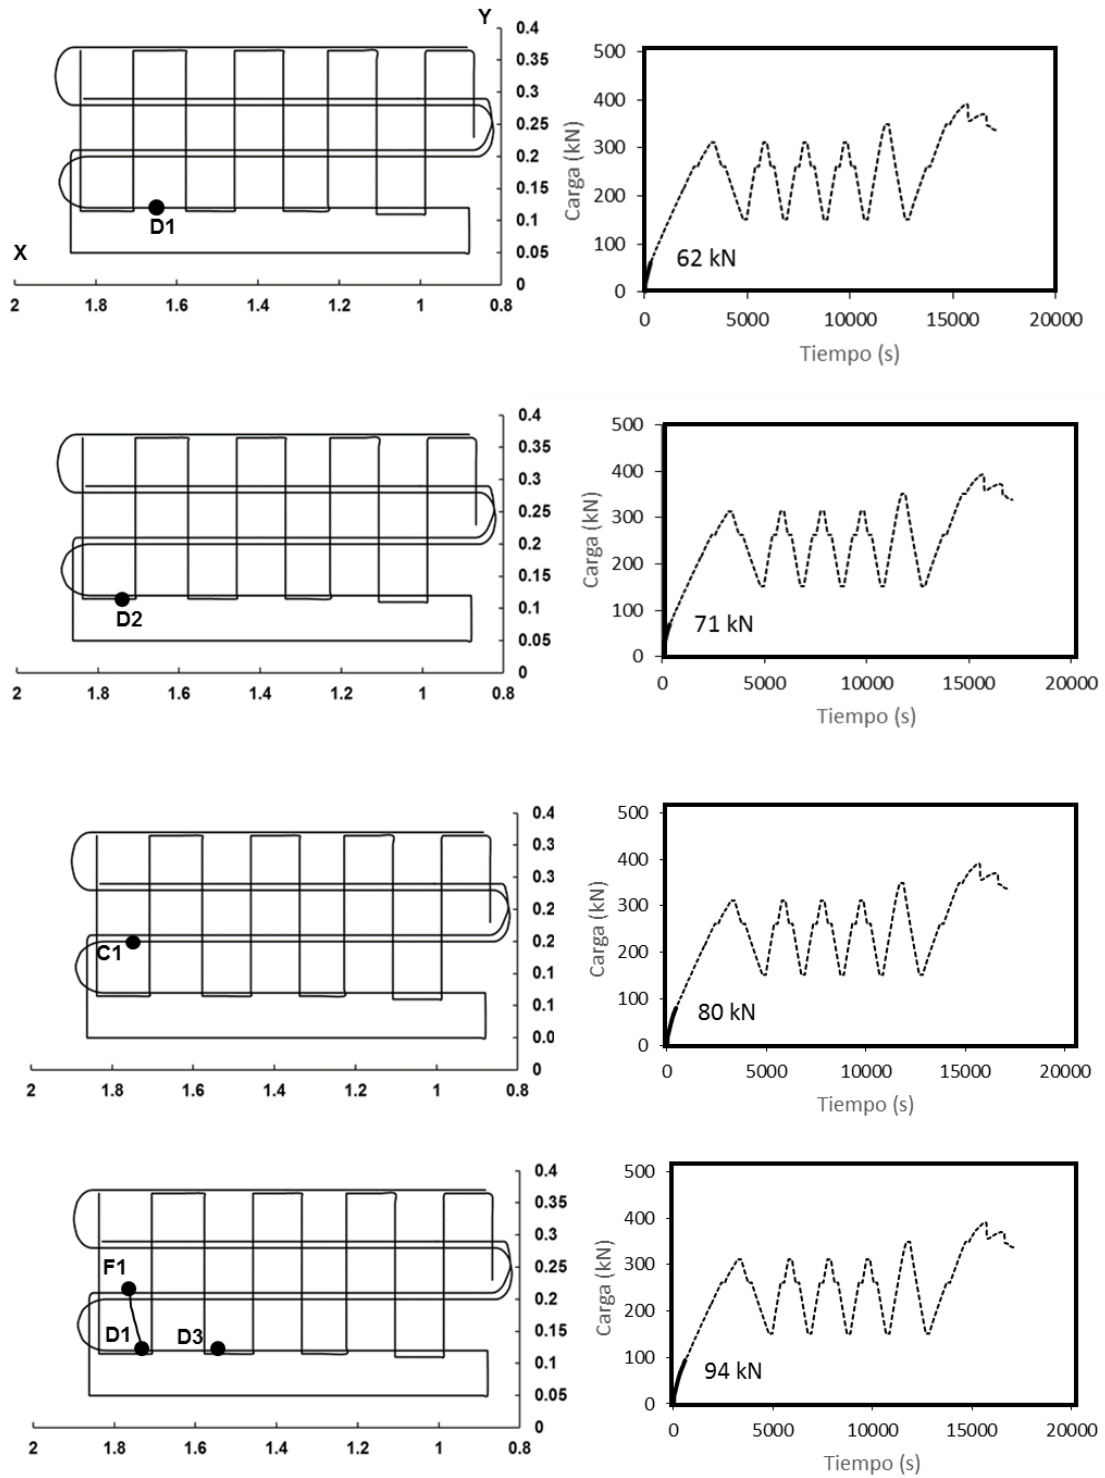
Patrones de fisuración de la viga I-1 (62 a 94 kN)
